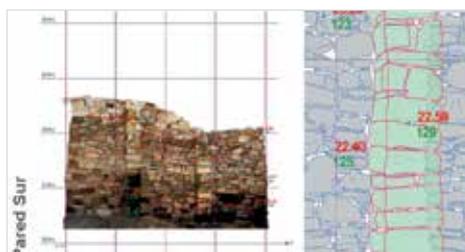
Fotoalzado y dibujo proyectado mediante transparencias sustractivas.
